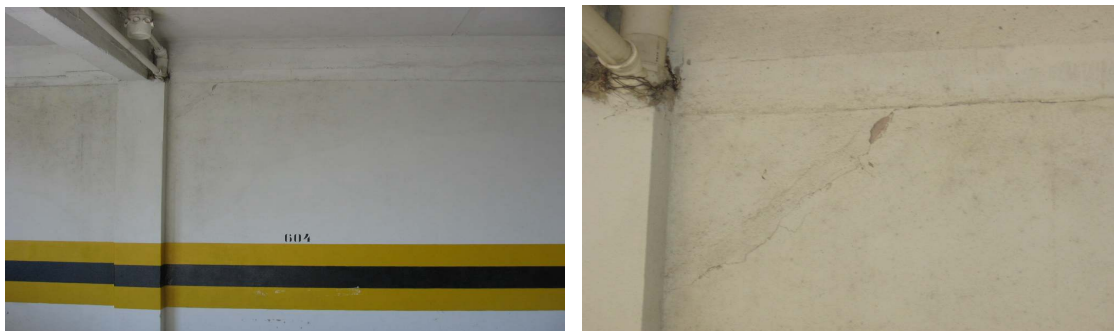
Fissura na parede abaixo da viga no pavimento garagem e 9b - a fissura em detalhe.
